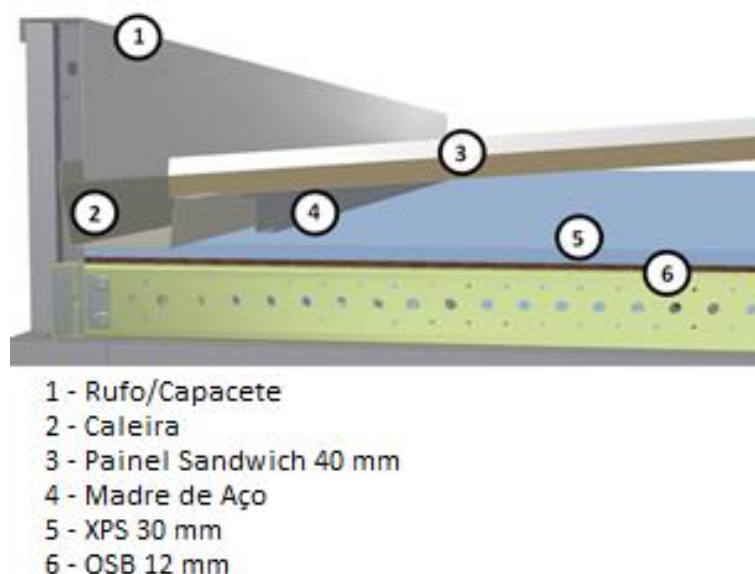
Corte transversal da cobertura utilizada na solução da TÉKETO (Téketo, 2012c)
